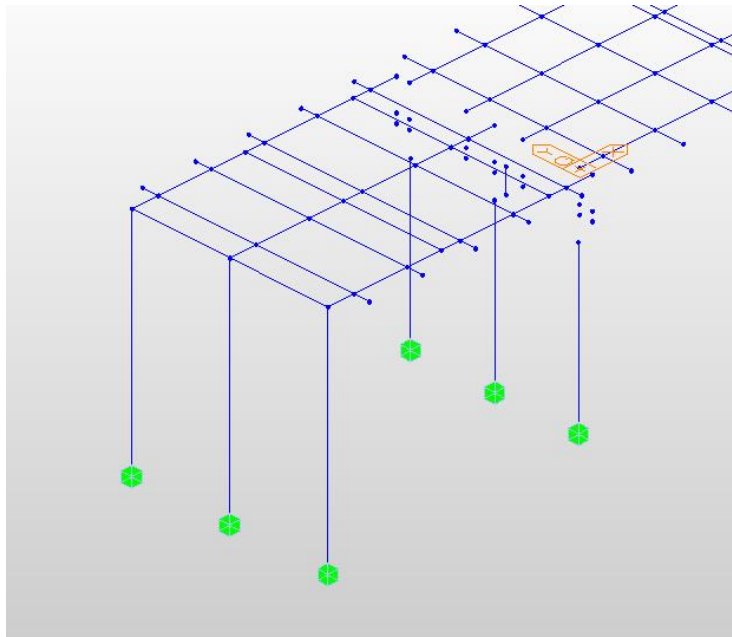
Vincoli pilastri. MidasCivil.
